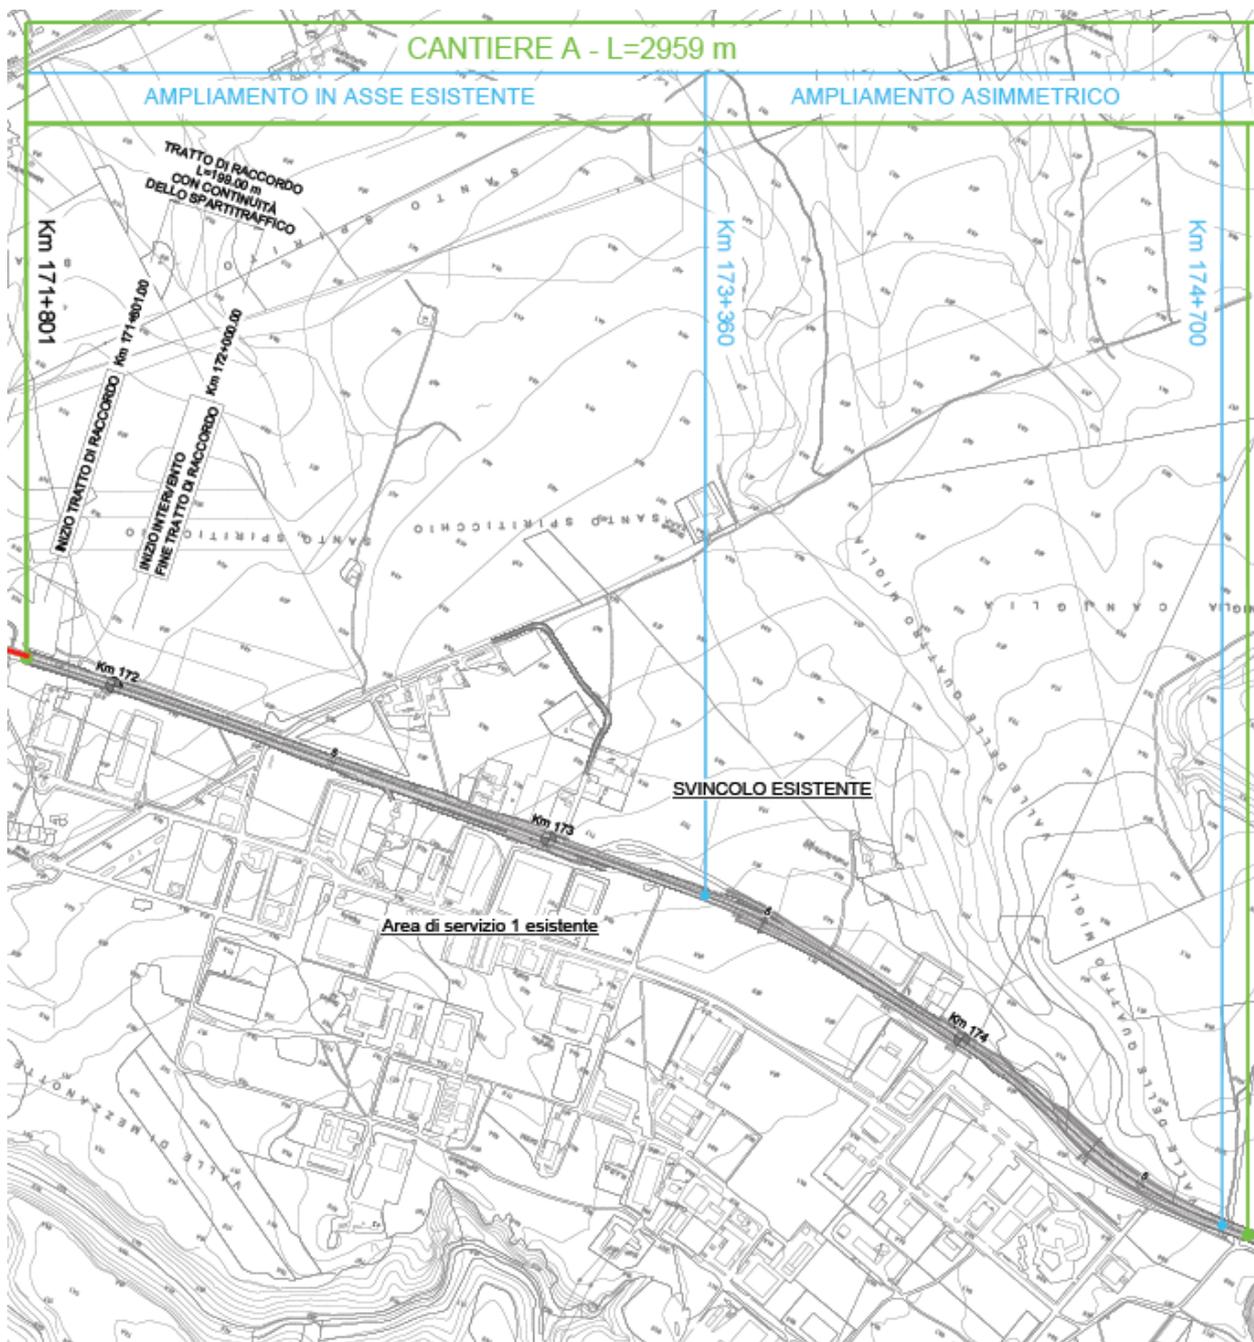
Stralci planimetrici con localizzazione Cantiere A
